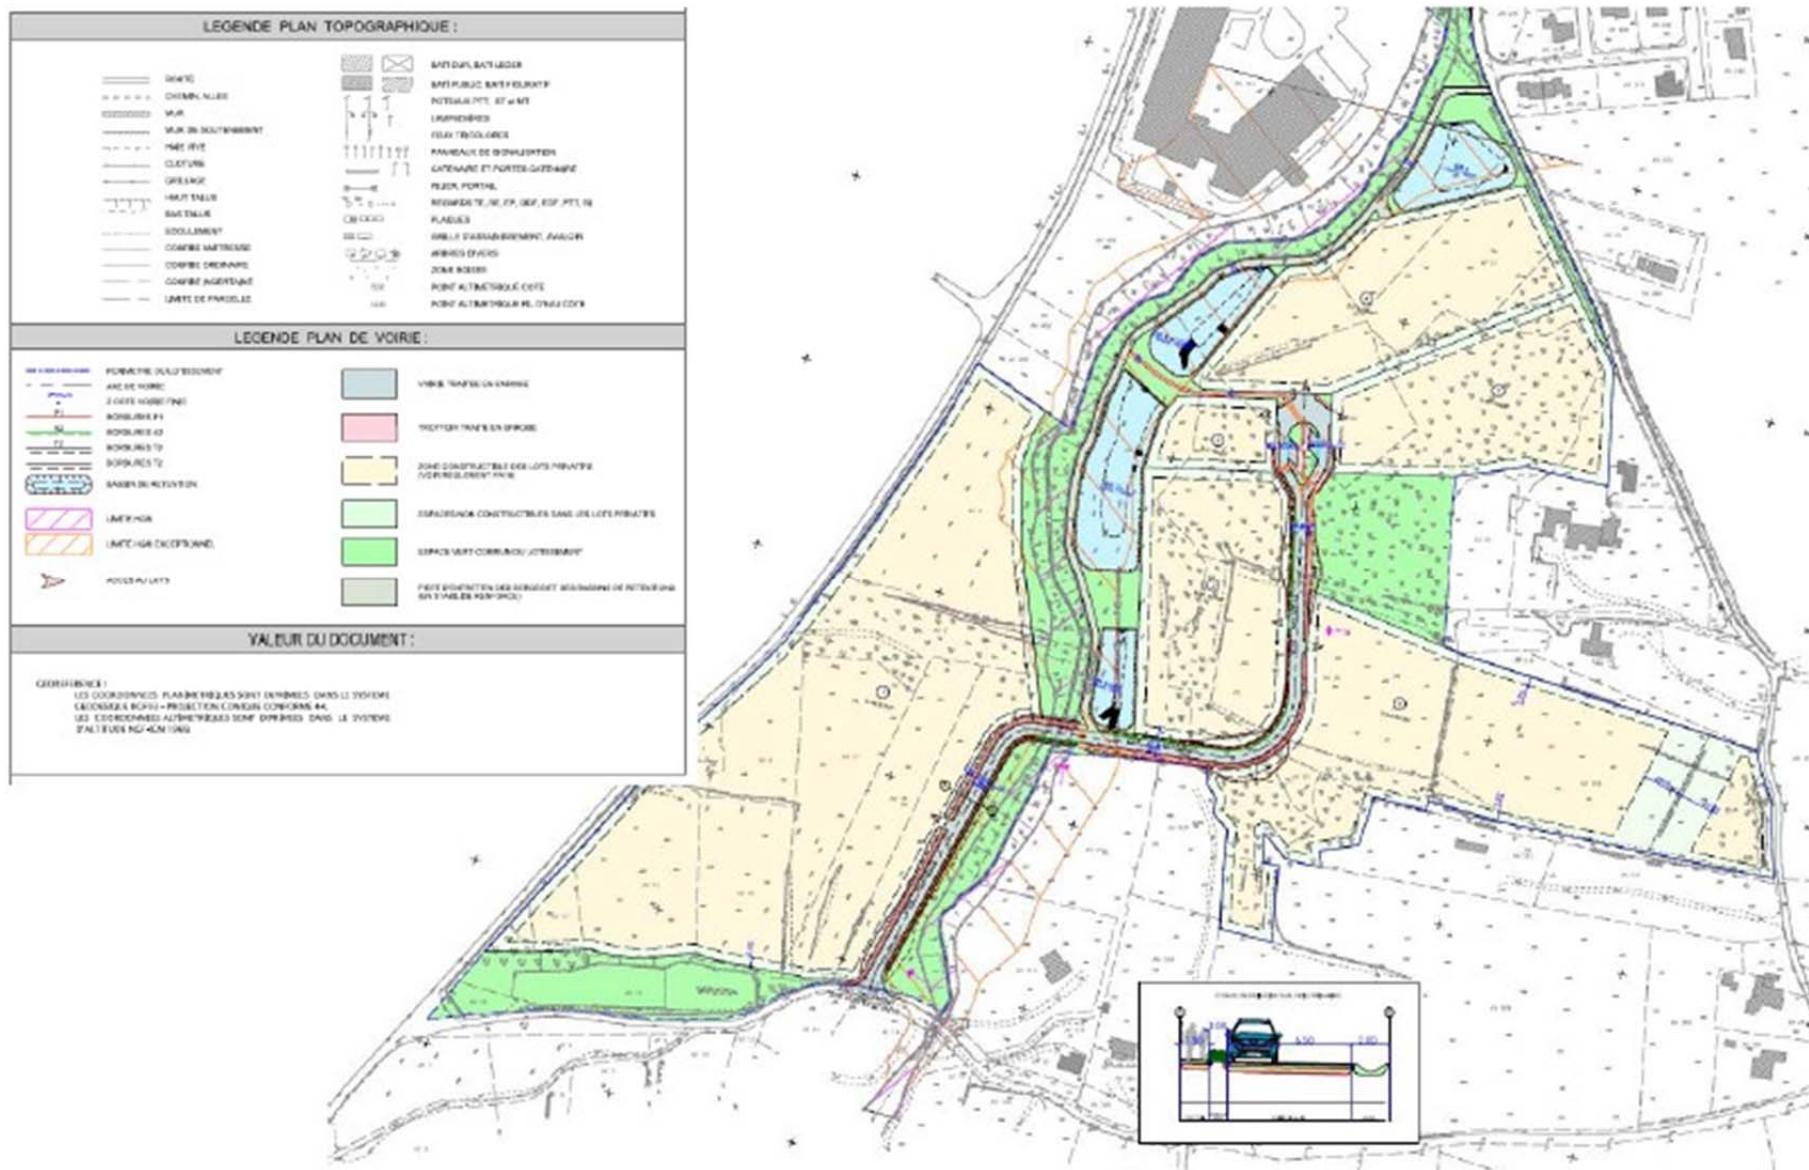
Plan masse du projet : voiries et bassins de rétention
